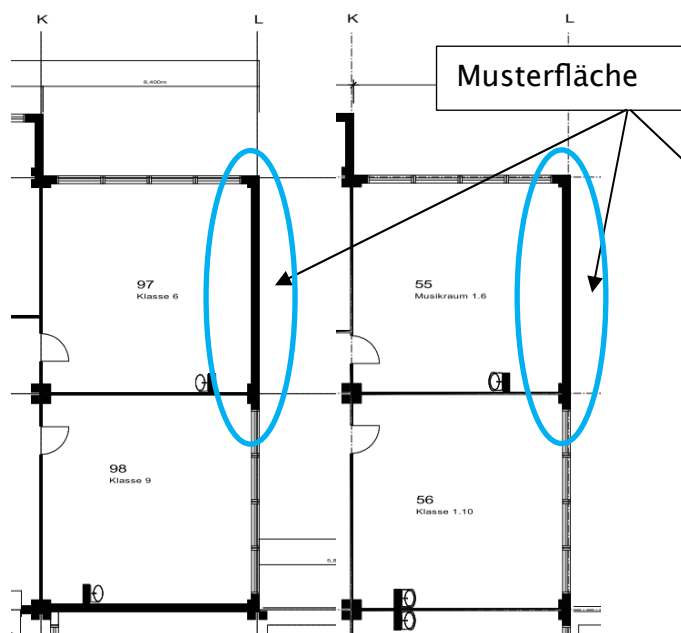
Auszug Grundriss EG / 1.OG
